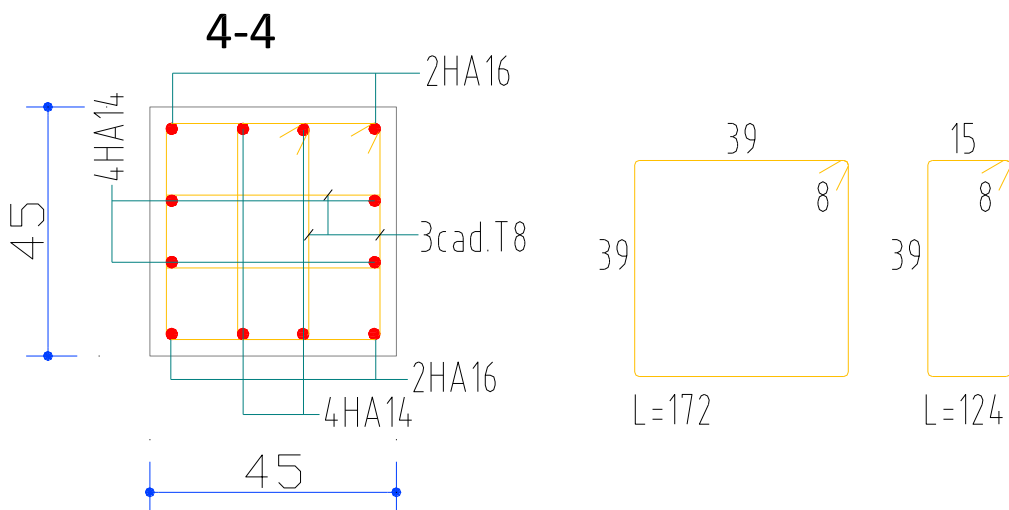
Coupe de ferrailage des poteaux $45 \times 45 \text{ cm}^2$.
